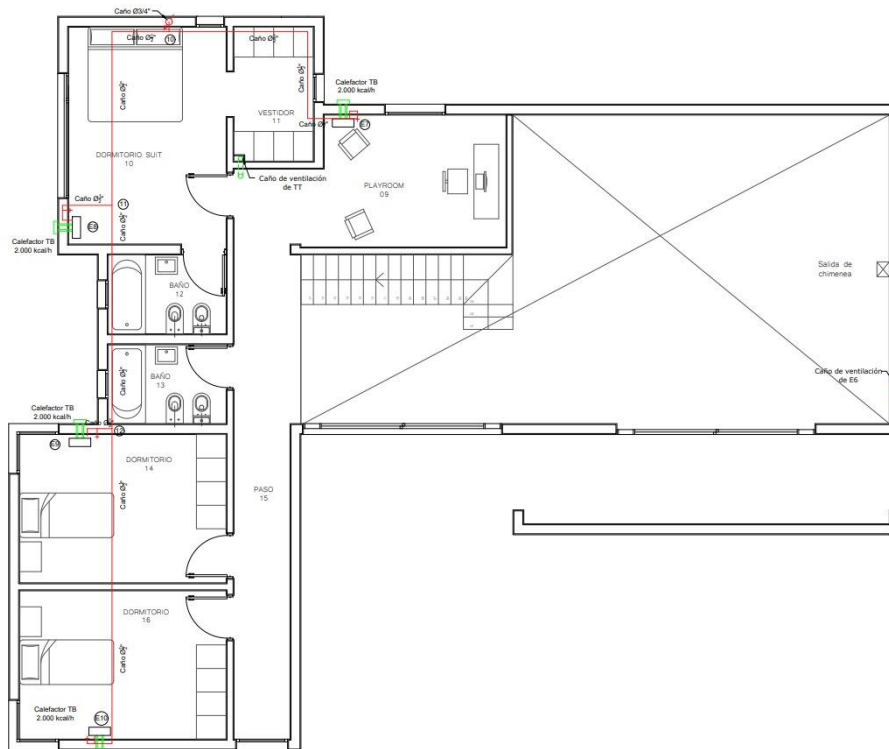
Trazo de cañerías de gas y ubicación de artefactos en planta alta
